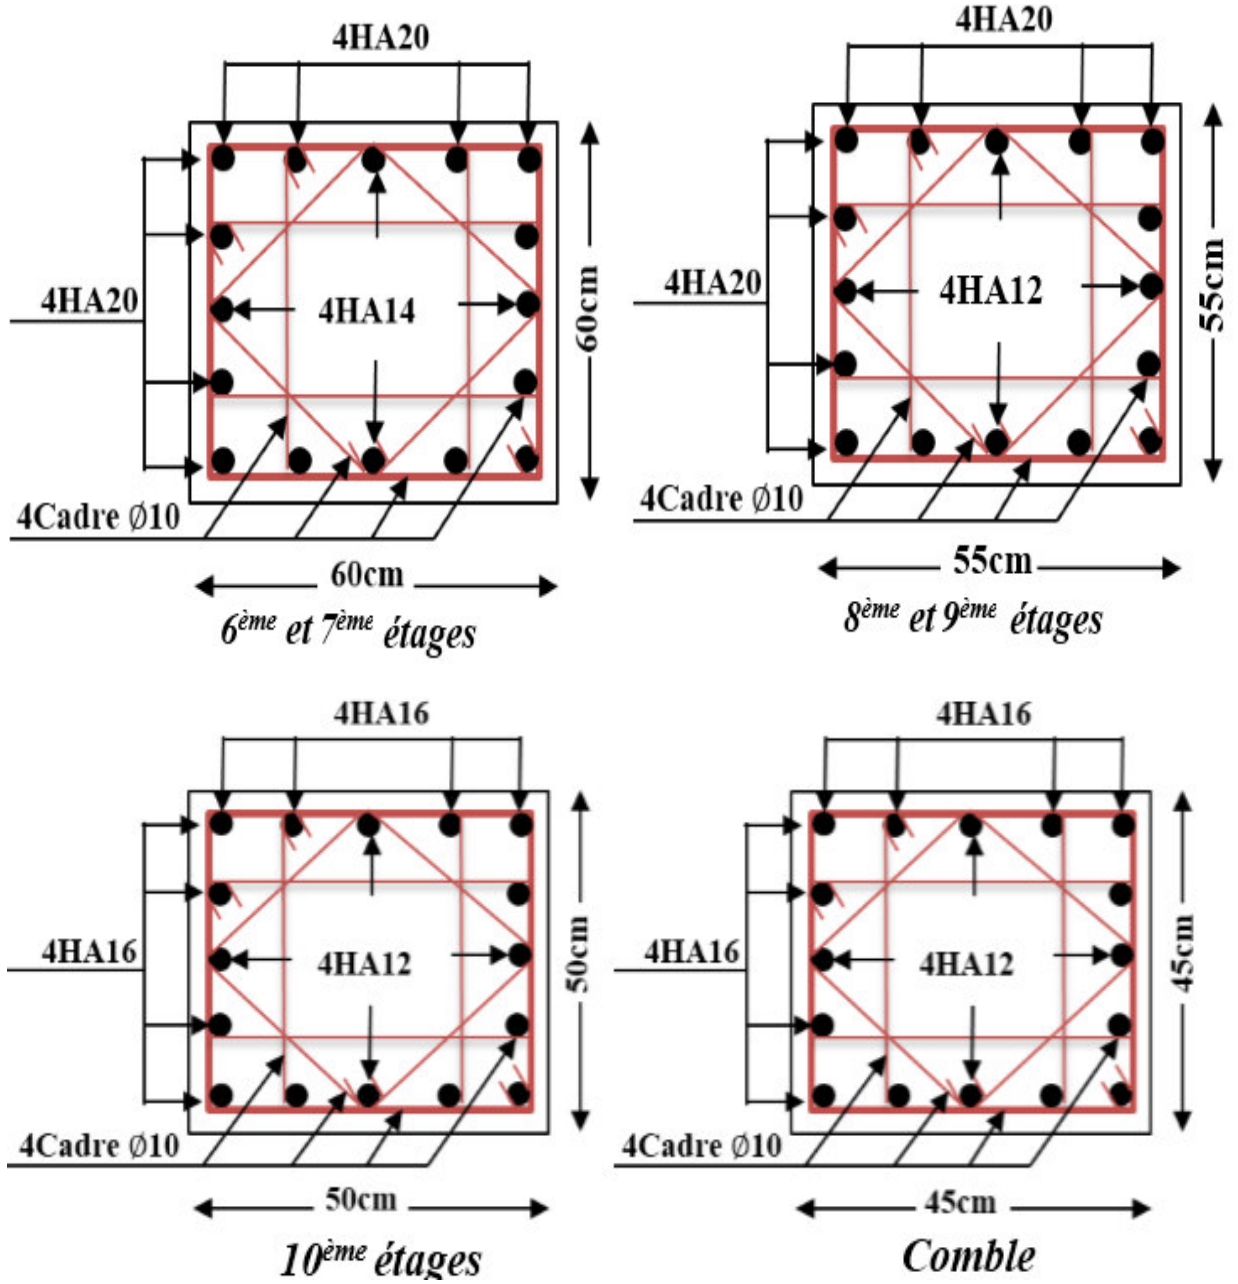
Schéma de ferrailage des poteaux de chaque niveau.
